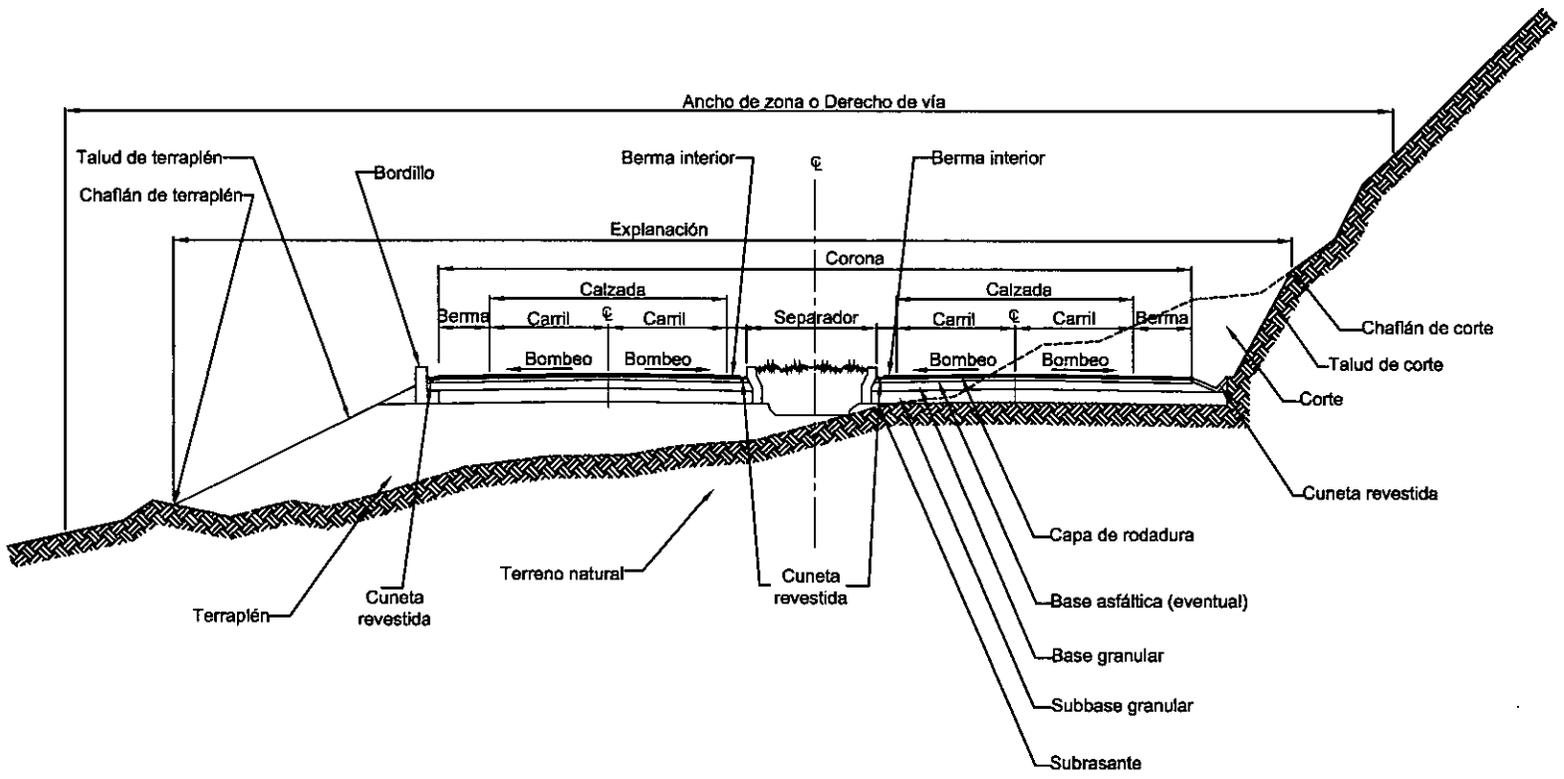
Sección transversal típica en vías de doble calzada
